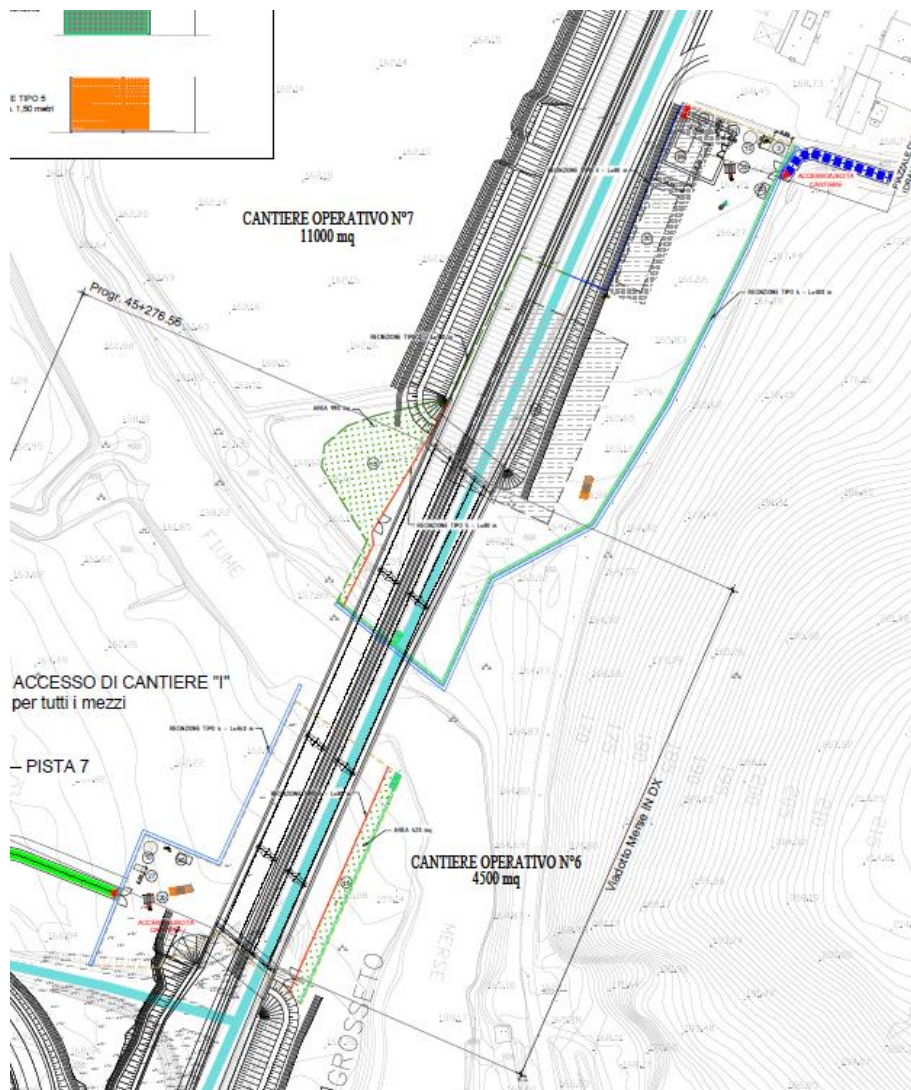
Planimetria cantiere operativo 6 e cantiere operativo 7.
